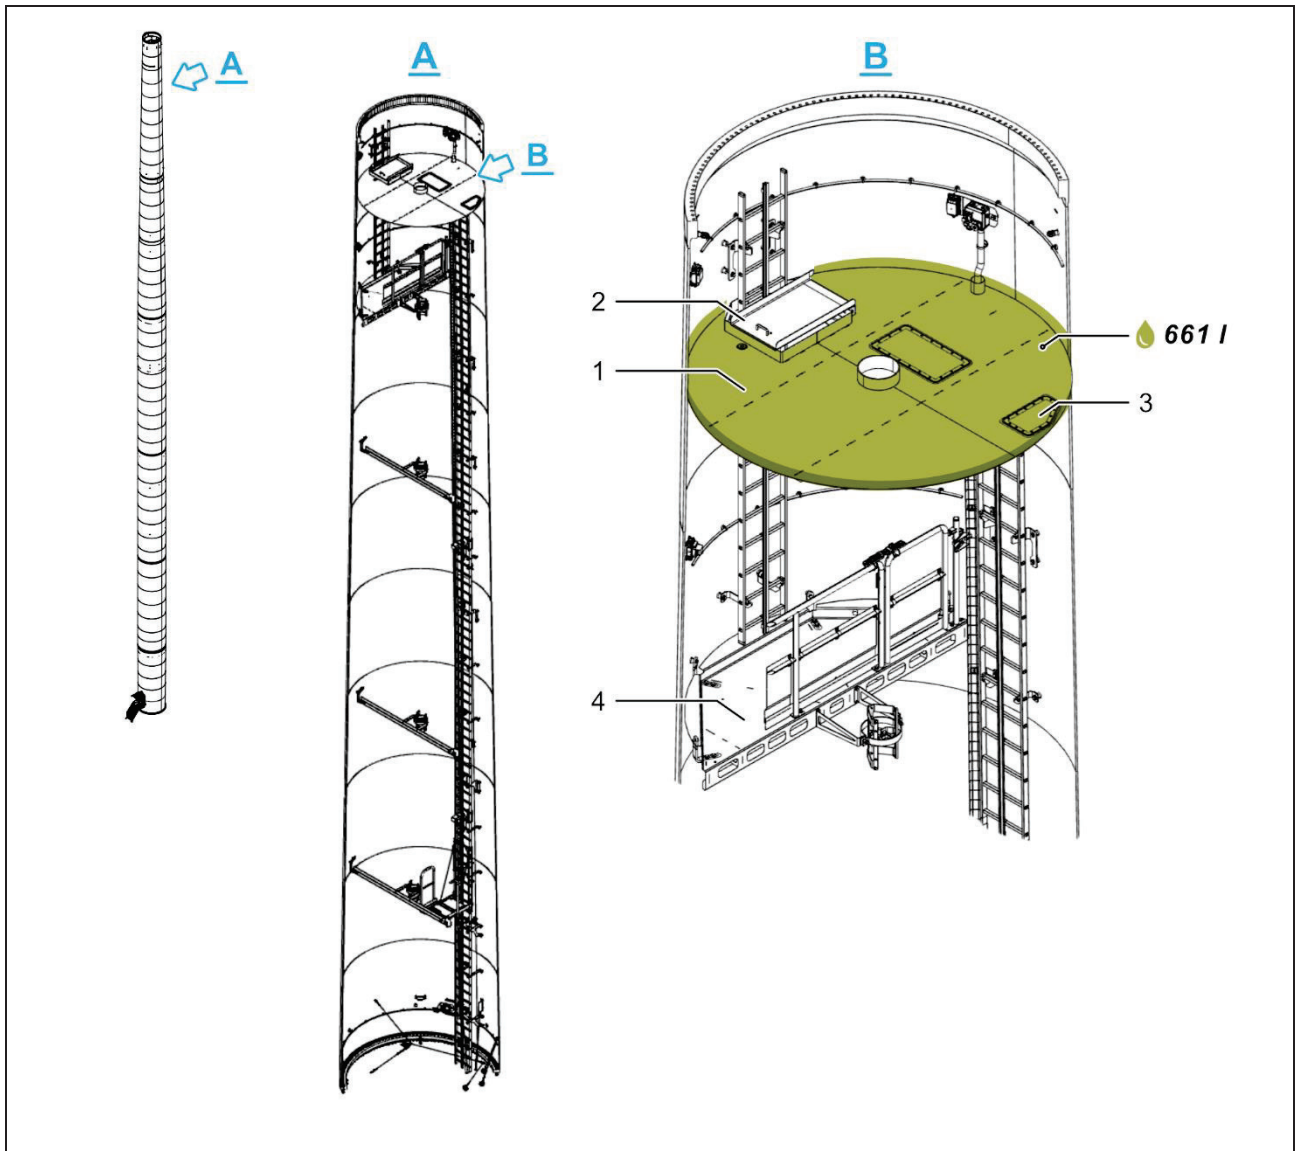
Öldichte Turmplattform (Abbildung beispielhaft)
